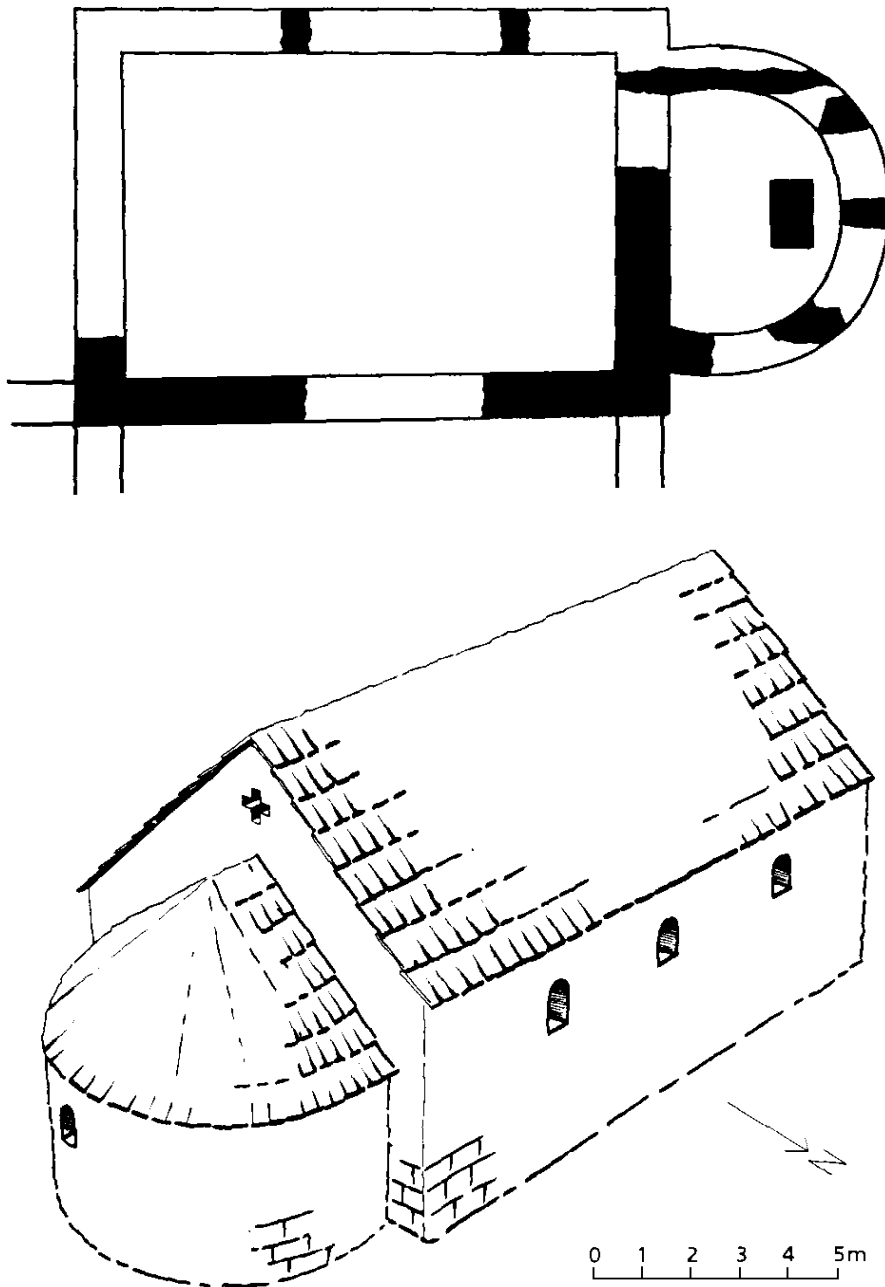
Martinskirche. Bau II, Grundriß und Rekonstruktion
